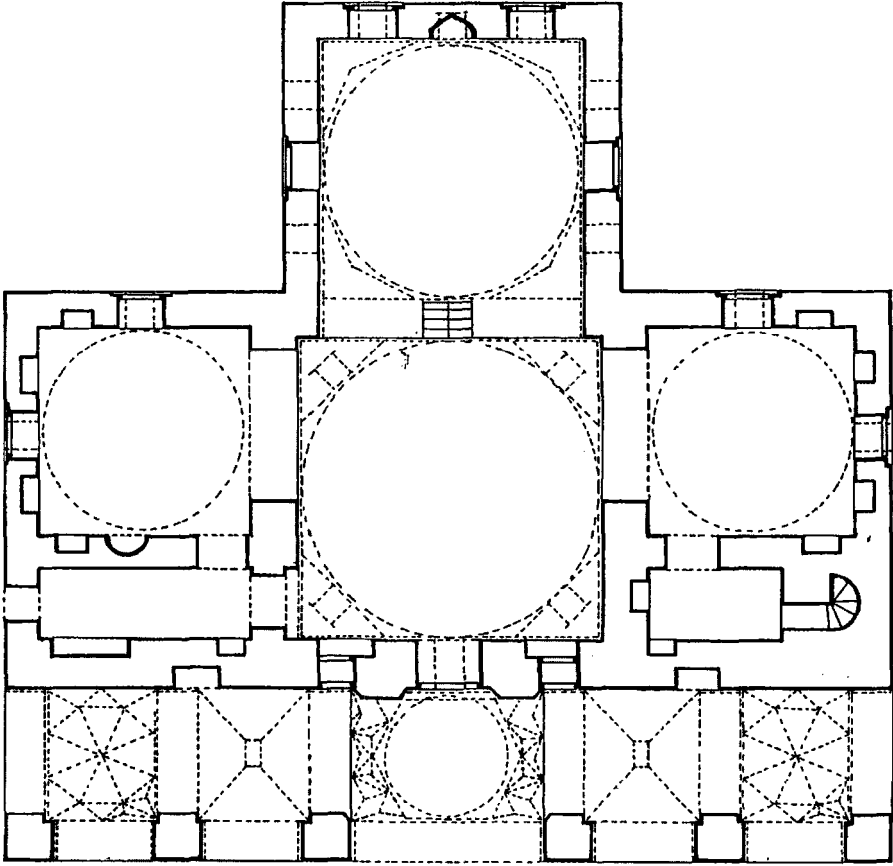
Tire Yeşil İmaret Camii planı (E.H.Ayverdi'den)
